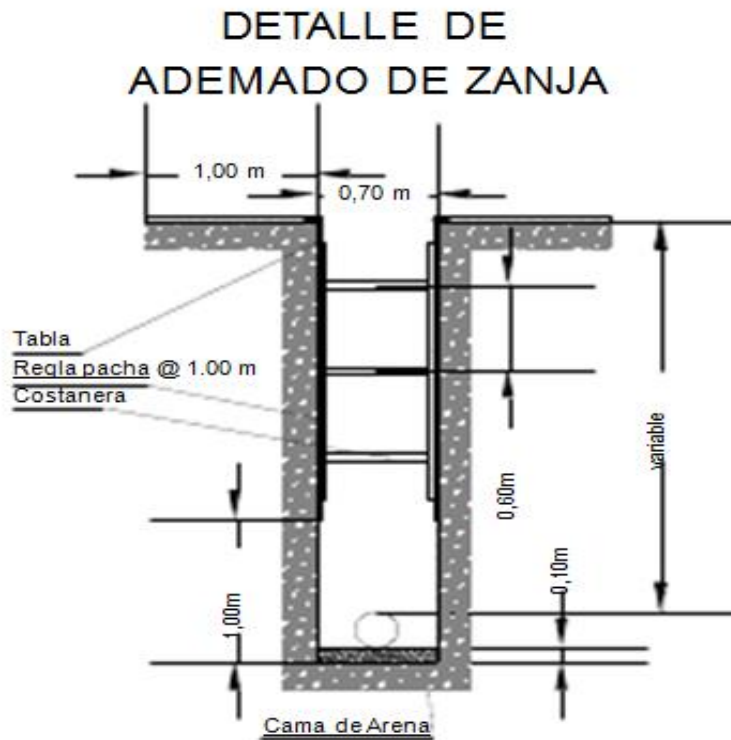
Detalle de ademado de zanja, Proporcionado por ANDA
